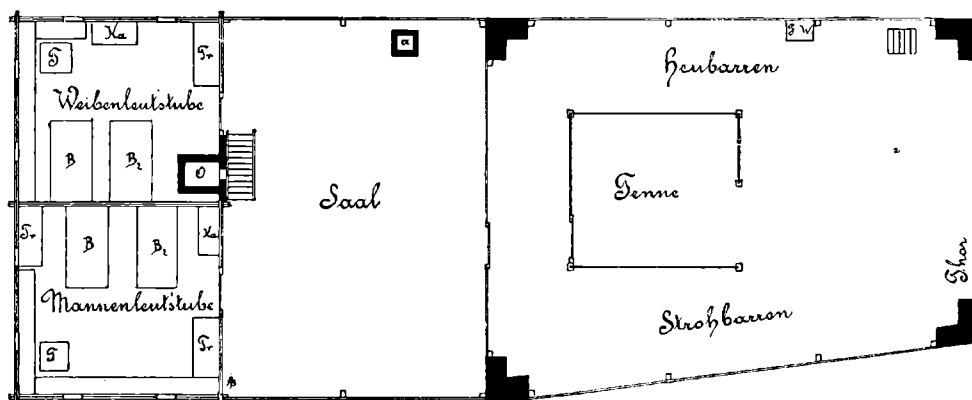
Grundriss des Obergeschosses des Schmied-Hauses.
